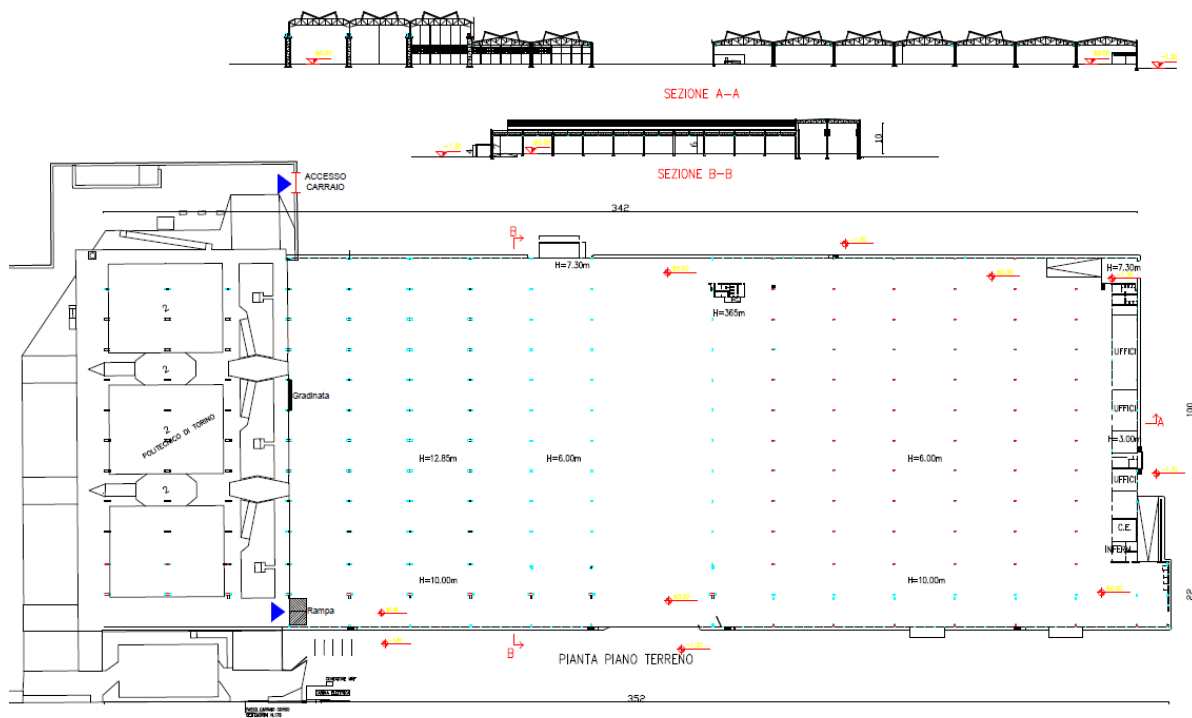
UMI2 – porzione Capannone ex DAI - Planimetria e sezioni
